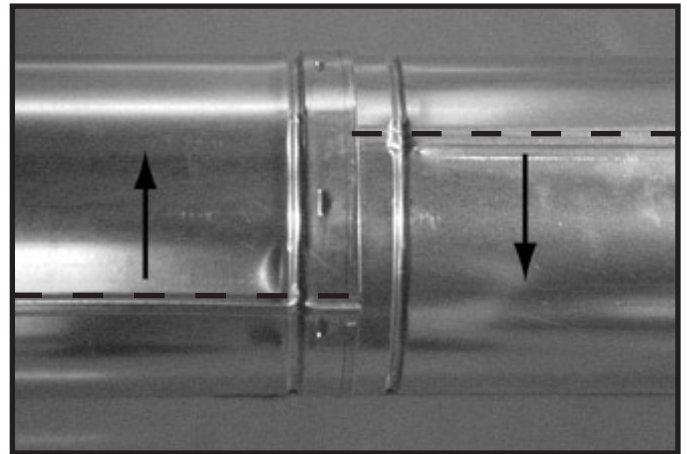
Pivoter les joints soudés pour démonter
